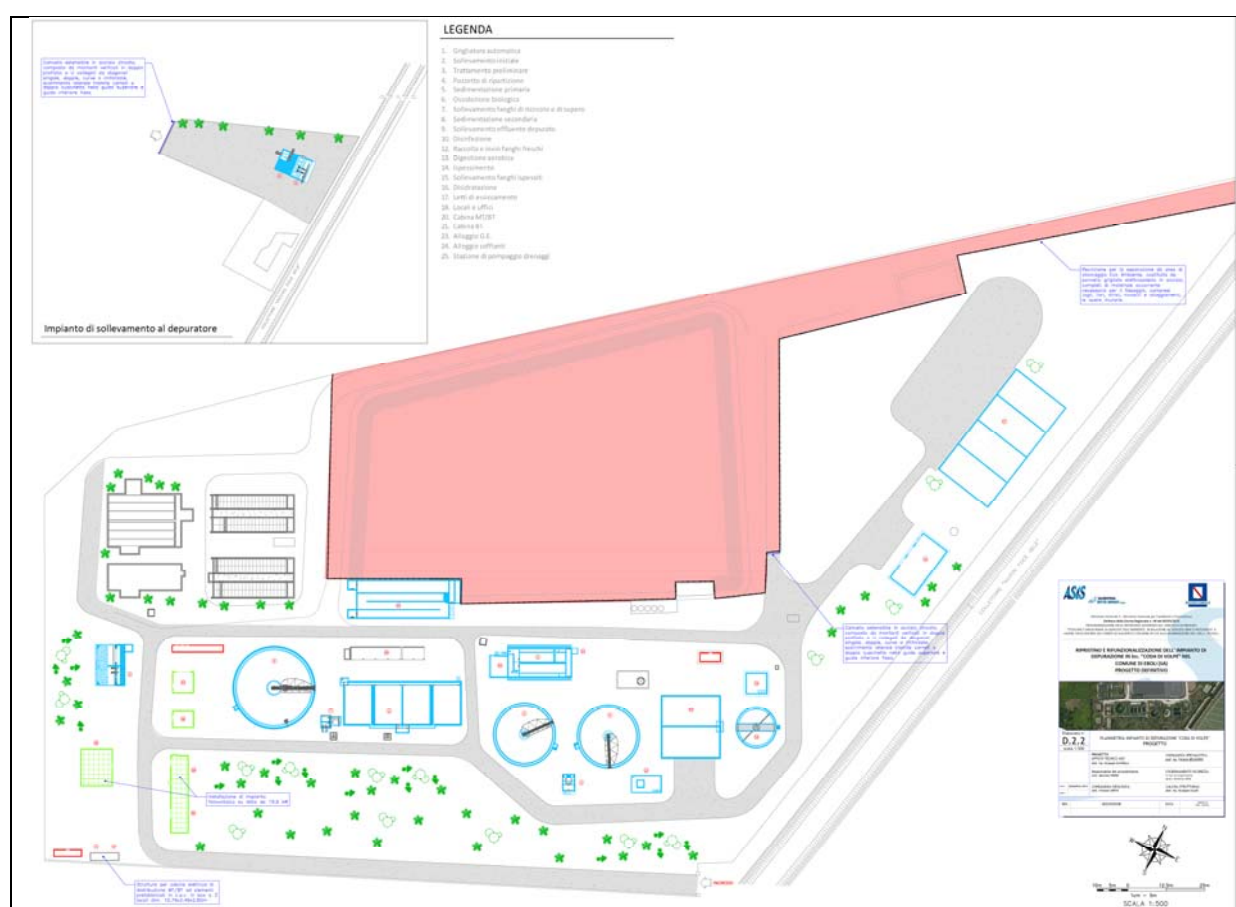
Planimetria generale di impianto (fonte: “Progetto definitivo – Ripristino e rifunionalizzazione dell'impianto di depurazione; sett. 2016; Elaborato D.2.2”)
